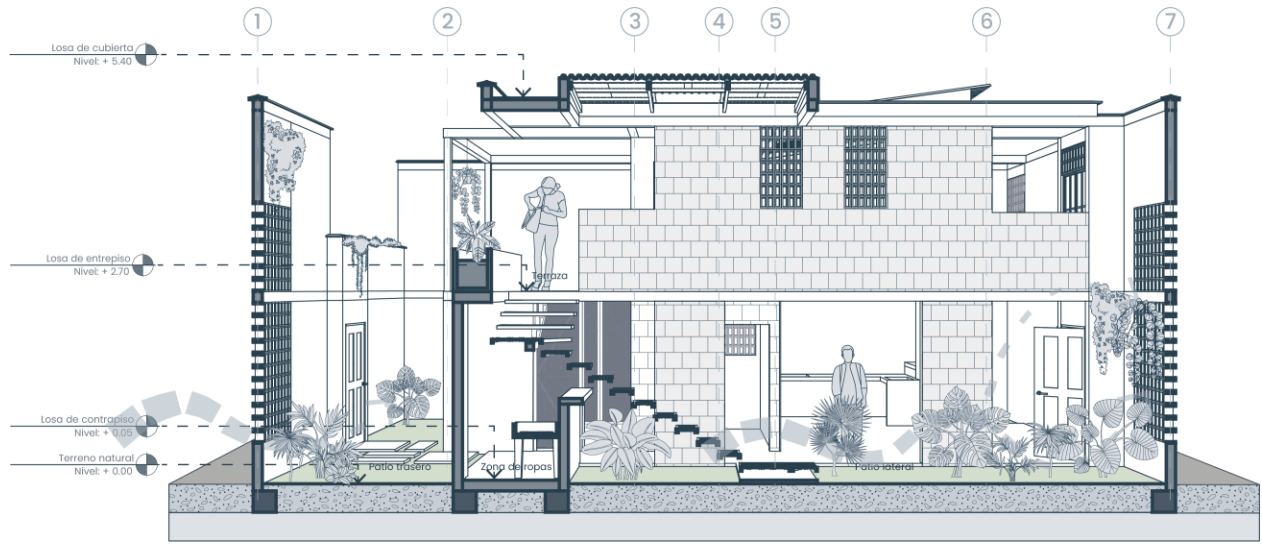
Planimetría Casa Patio. Elaboración propia.
